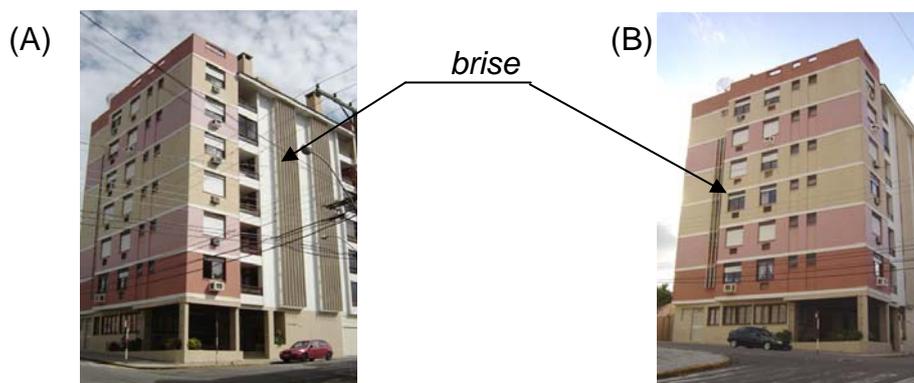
Vistas externas – (A) Ed. Romênia (B) fachada Sul
